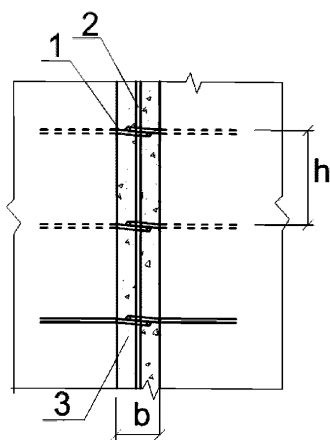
Бесшпоночные соединения в виде замоноличенных бетоном арматурных выпусков: 1 – выпуски петлевые арматурные (возможно из тросов $\phi 6-9$ мм); 2 – вертикальный стержень арматурный $\phi 10-12$ мм; 3 – бетон замоноличивания
